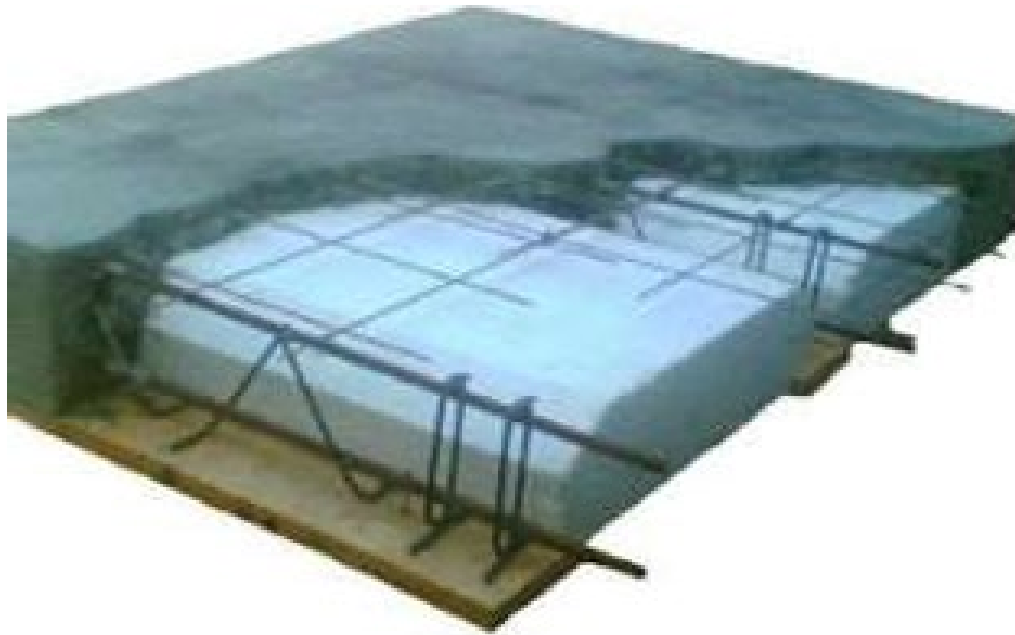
Конструкція монолітної плити перекриття з утепленням
